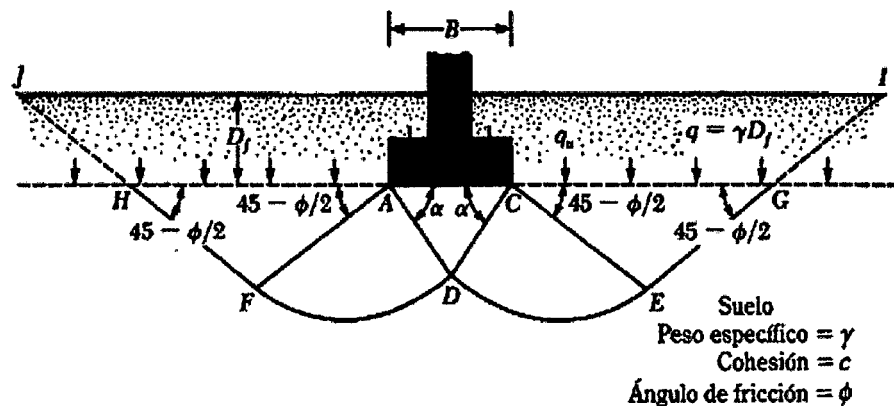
Falla por capacidad de carga en suelo bajo una cimentación rígida corrida.
